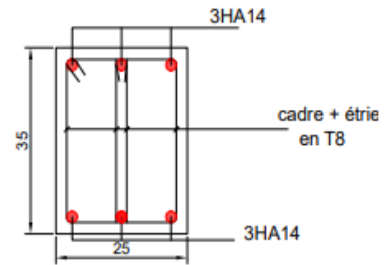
Ferrailage des poutres principales (Zone 1,2,3)
